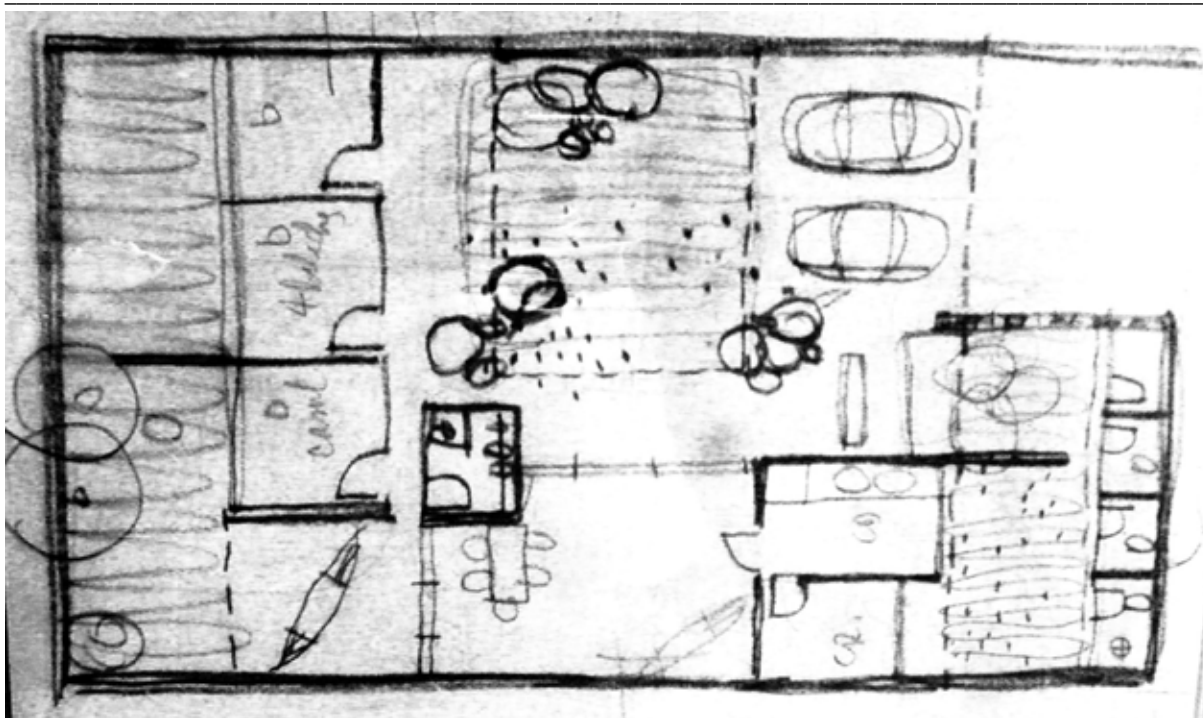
planta da Casa Giocondo Artigas (croqui encontrado no setor de Obras Raras da Biblioteca da FAU USP). Reparar que o muro frontal, em pedra, conforma um volume vazado em que se instalam chuveiros de praia e pequenos banheiros de serviço. As esquadrias da sala, em alumínio e vidro, são totalmente rebatíveis para as paredes laterais, de modo a garantir transparência e continuidade espacial.
